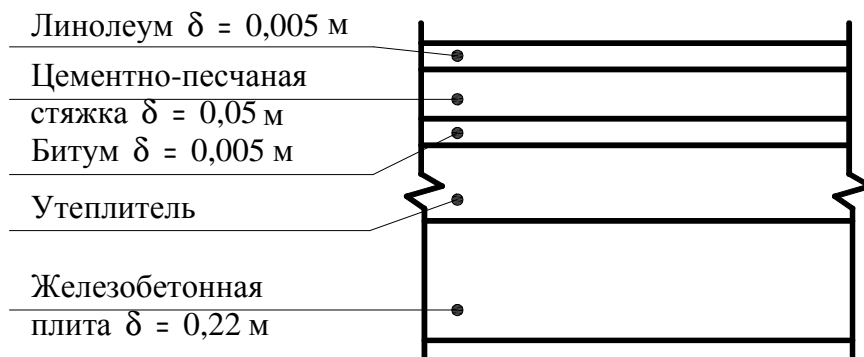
Конструкция перекрытия над неотапливаемым подвалом
